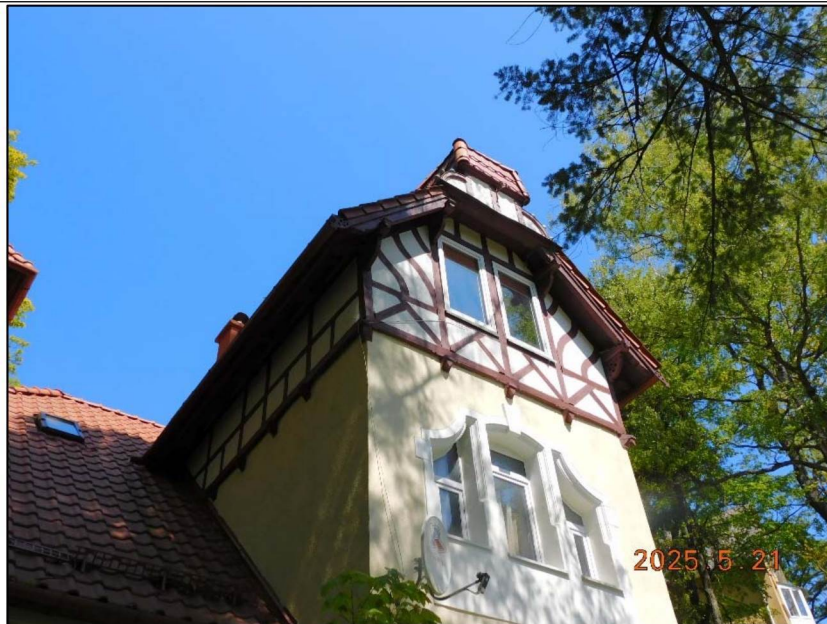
Вид фахверка на фронтальной южной стене и боковой западной стене восточного ризалита южного фасада.
